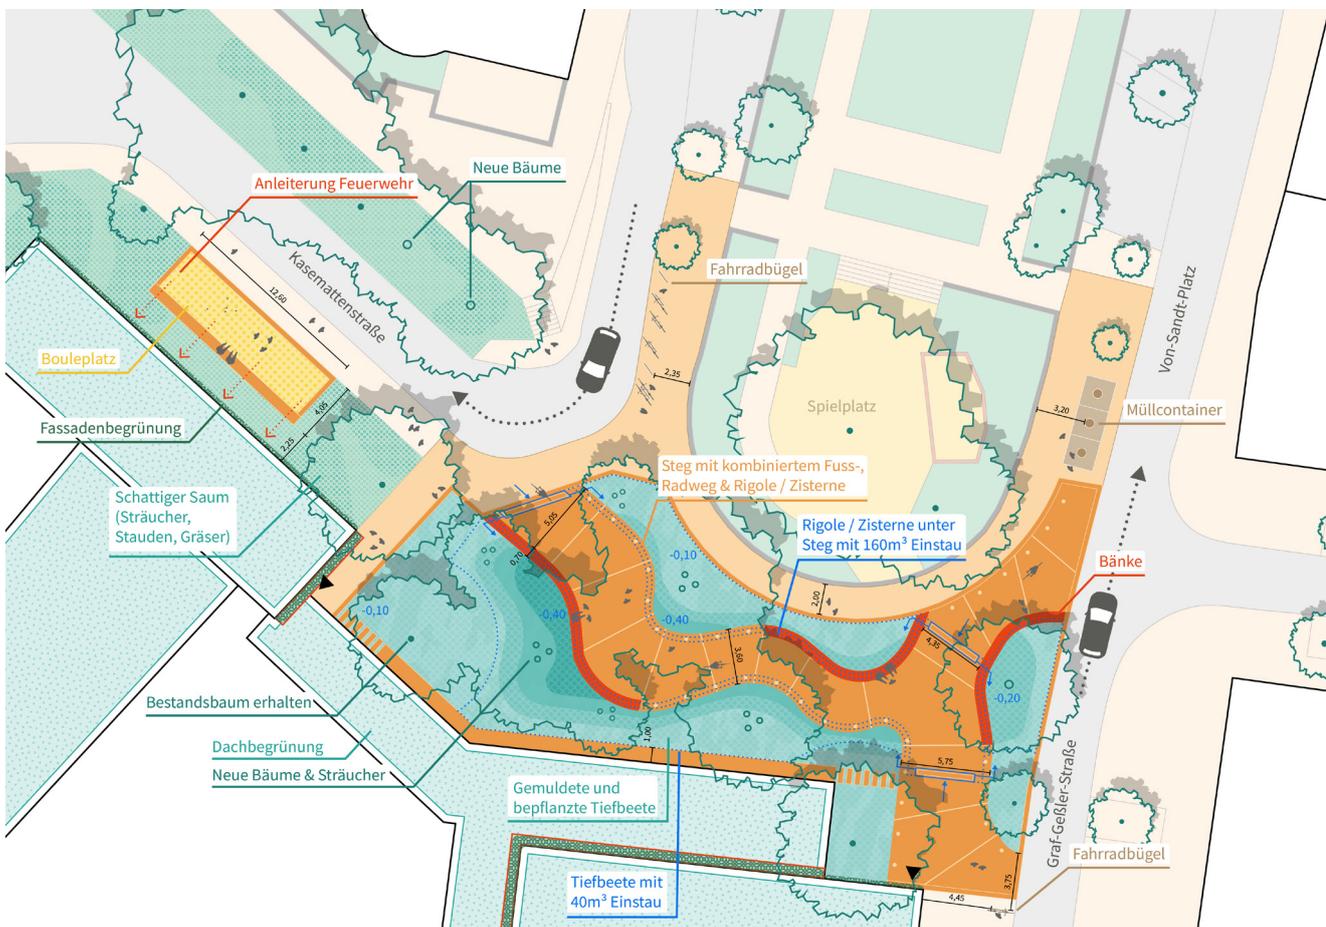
Vorschlag 3.1.A – Grundriss Gesamtsituation
